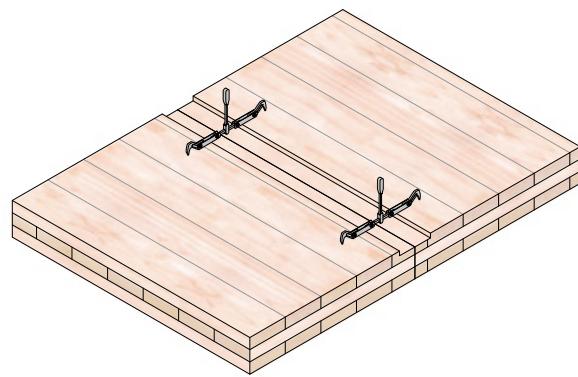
Unión de paneles adyacentes con tirapanel con gancho.
